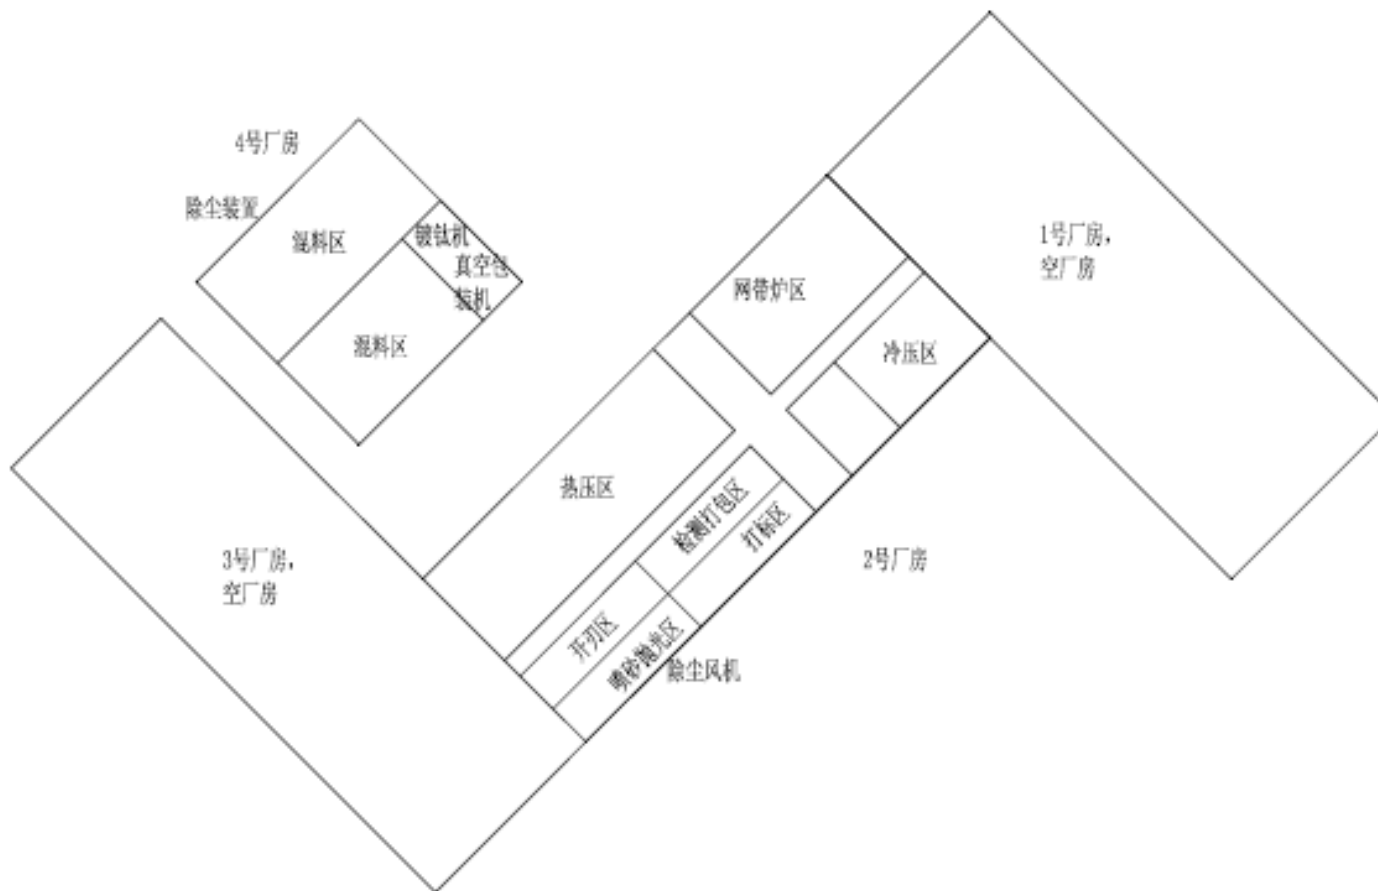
现有工程1、2、3、4号厂房平面布置图
